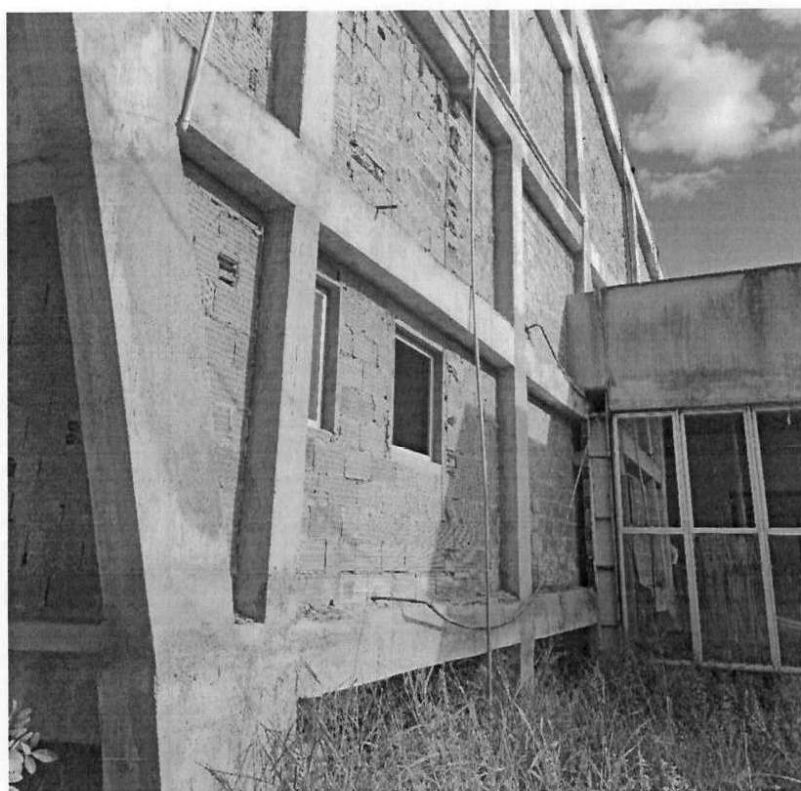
Mato ao entorno da estrutura – instalações expostas / janelas
